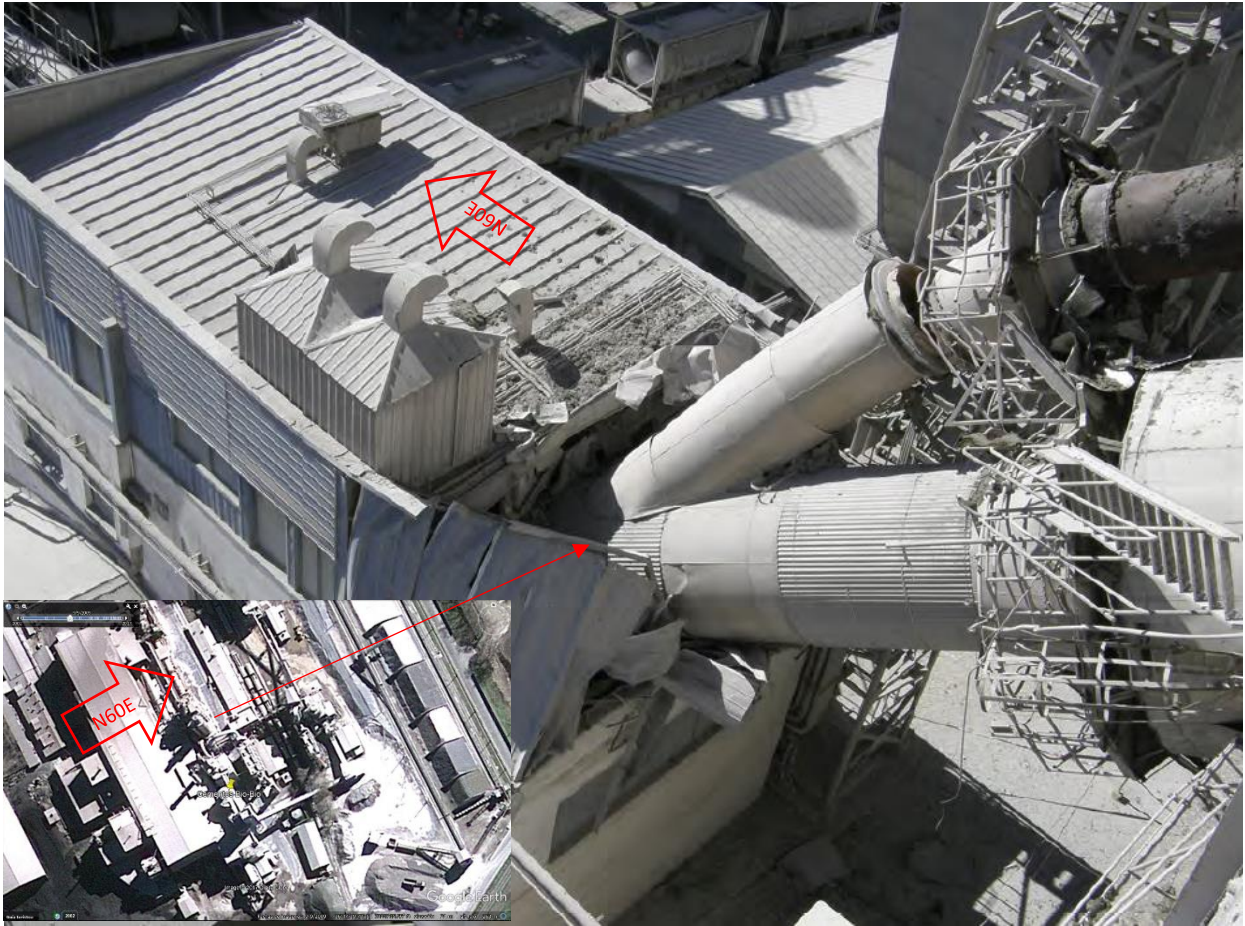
Daños en planta Cementos Bío-Bío [65].
